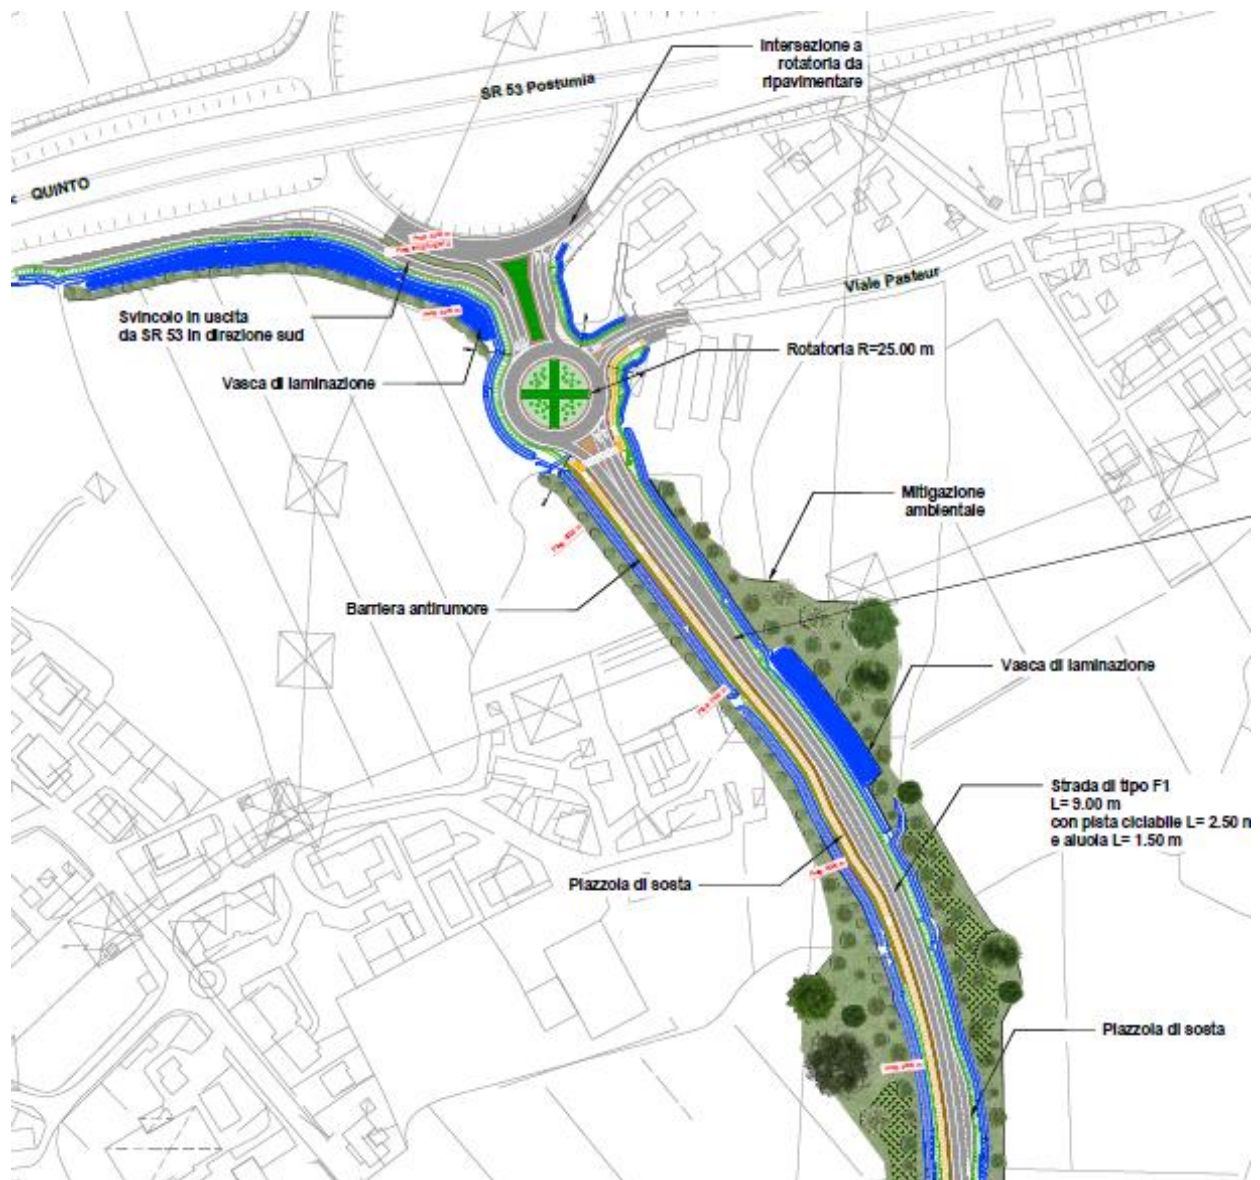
Stralcio progetto del nuovo asse viario in corrispondenza dell'attestazione con la SR 53 Tangenziale di Treviso
